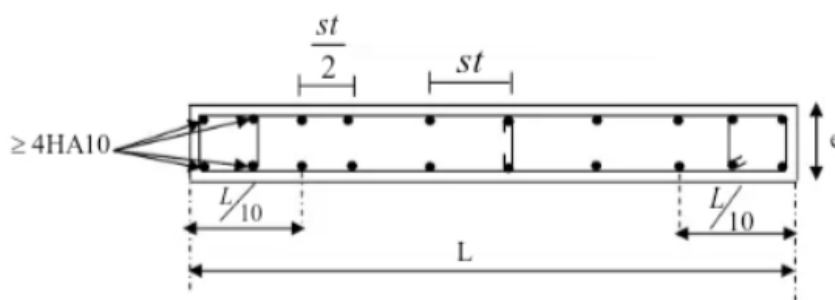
Disposition des armatures verticales dans les voiles
